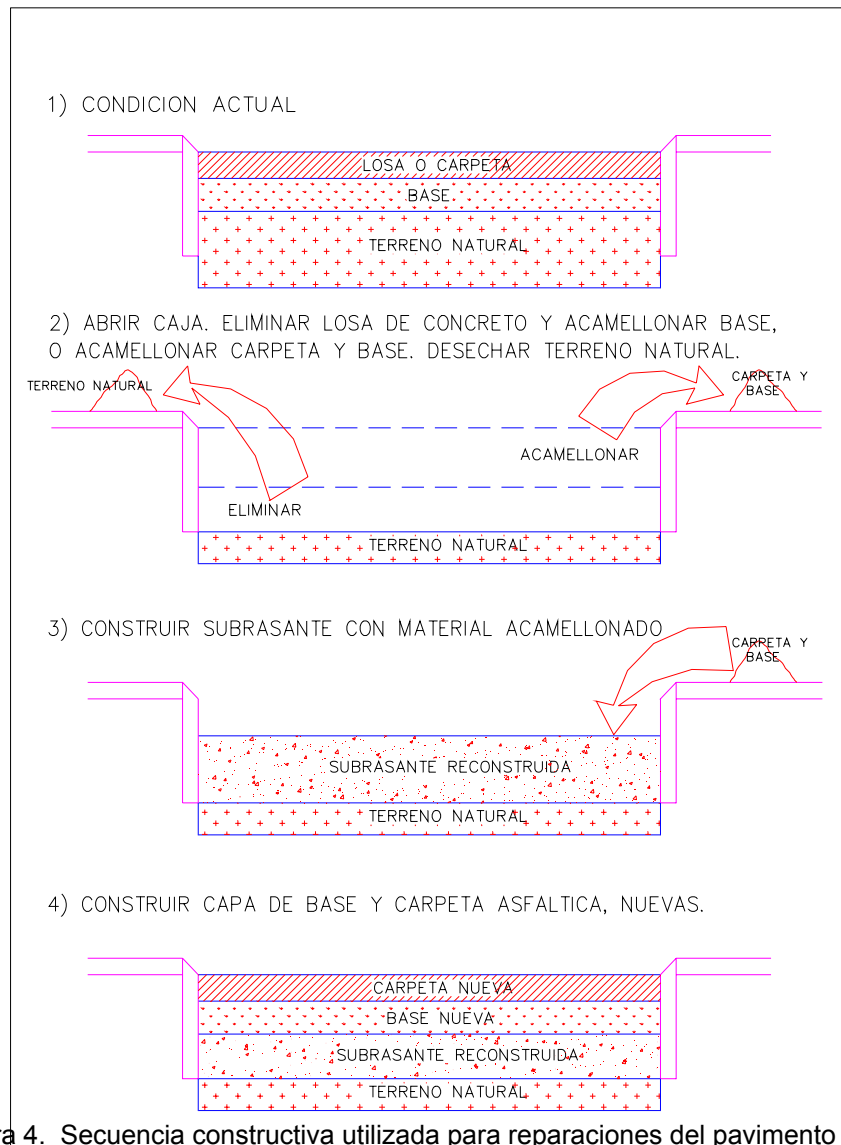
Secuencia constructiva utilizada para reparaciones del pavimento existente.
